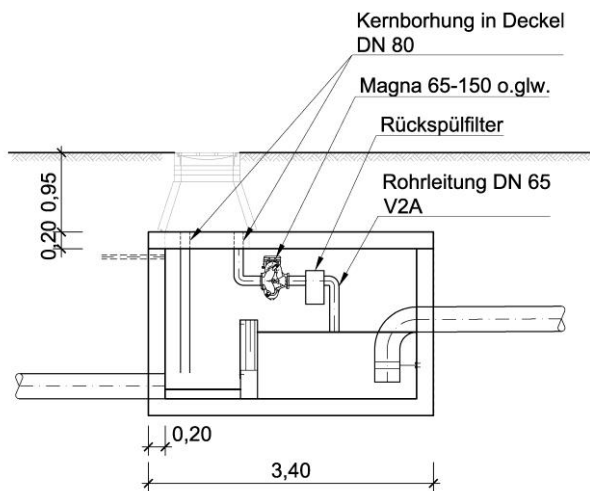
Installationen Drainagewasserfassung Schacht Nr. 10
